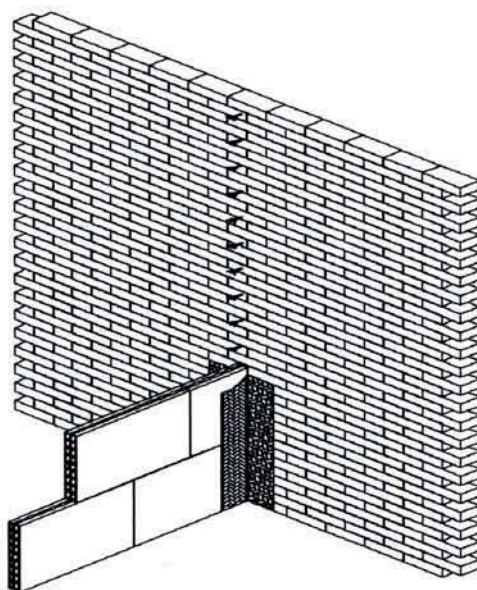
Detalle de la unión con flejes metálicos y colocación de la malla
